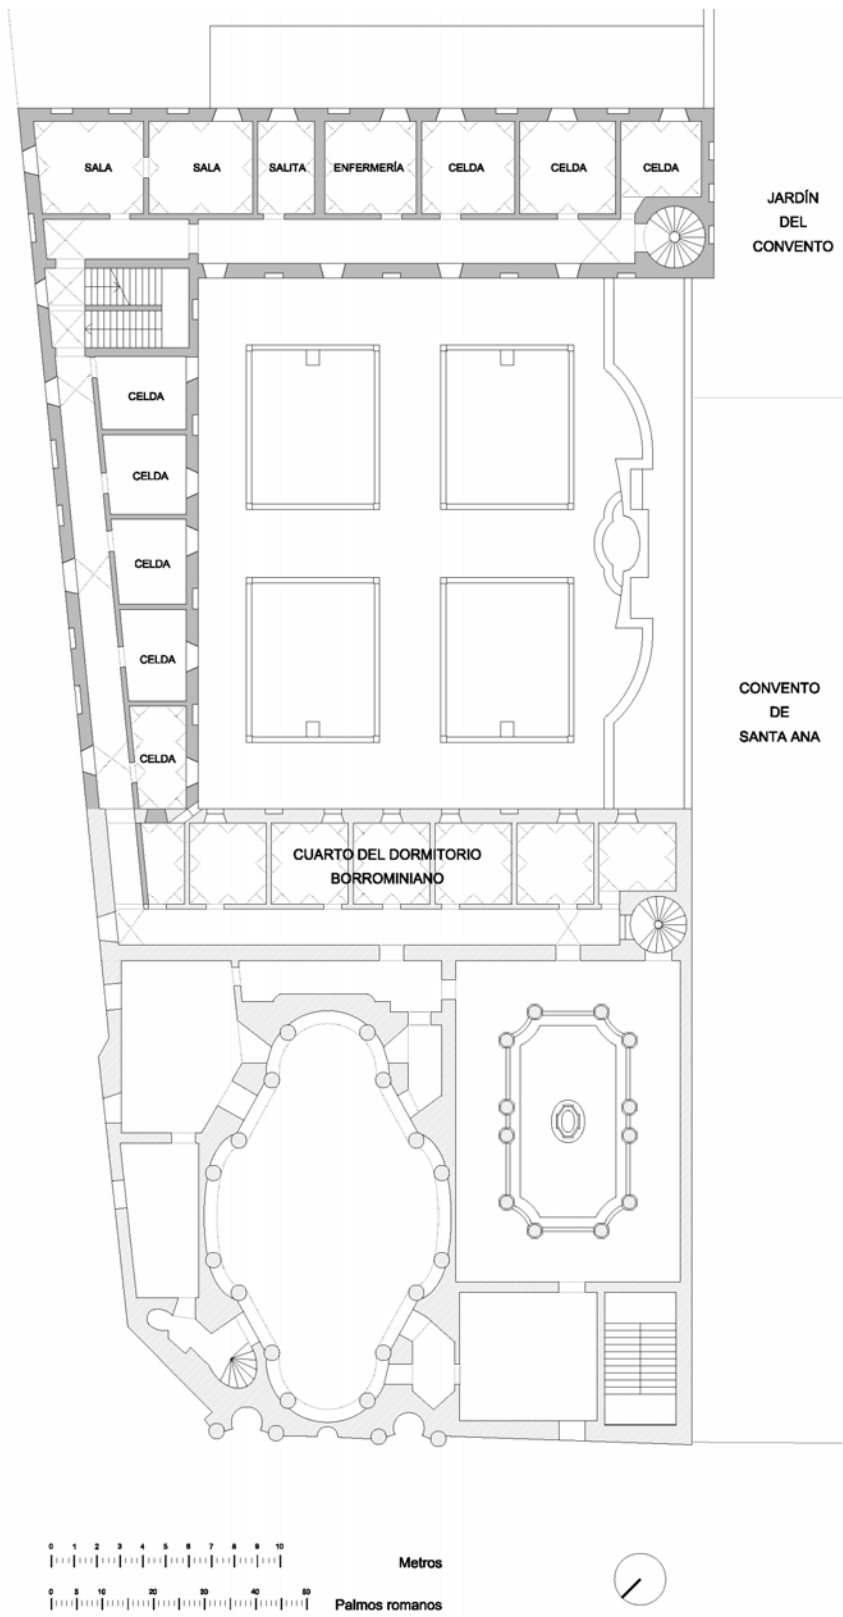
Disegno dell'autrice. Pianta primo piano.
